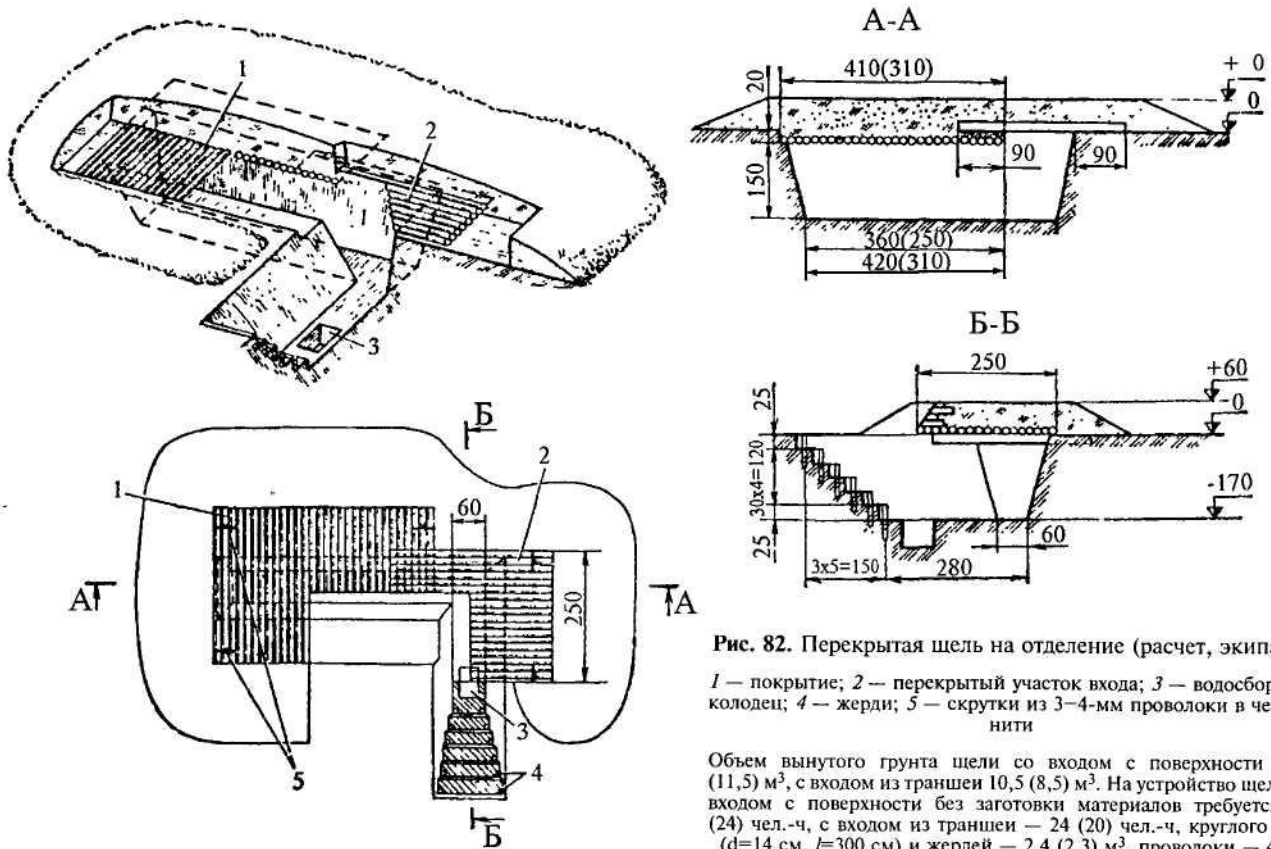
Перекрытая шель на отделение (расчет, экипаж):
